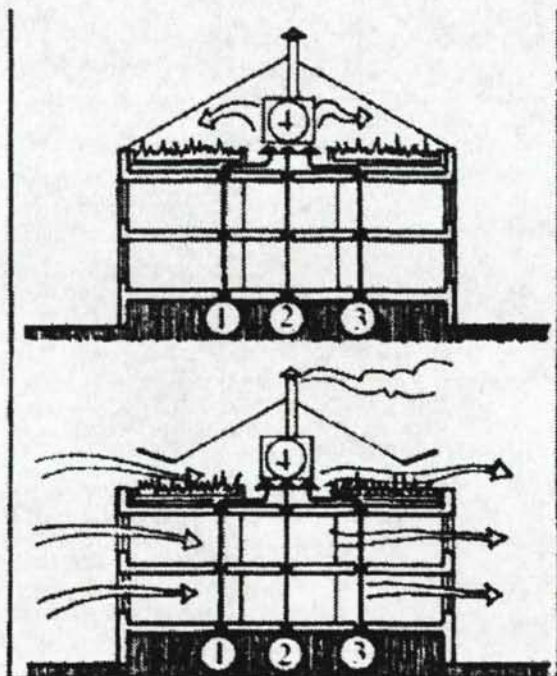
Использование тепловой энергии удаляемого воздуха для отопления теплиц, расположенных на крыше жилого дома: 1-вытяжка из камина; 2-вытяжка из кухни; 3-вытяжка из ванной; 4-теплообменник для тепловых выбросов камина, кухни, ванной
